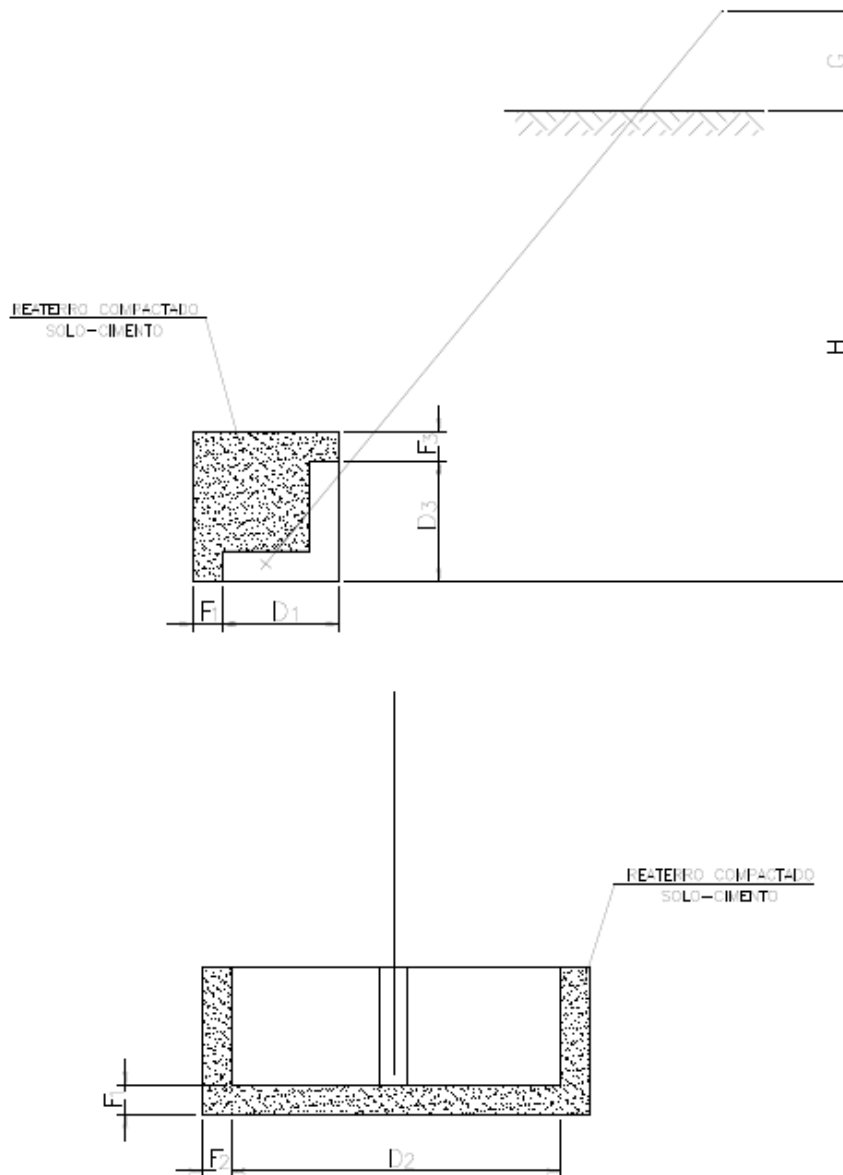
Viga Pré-Moldada Típica p/ Estai
